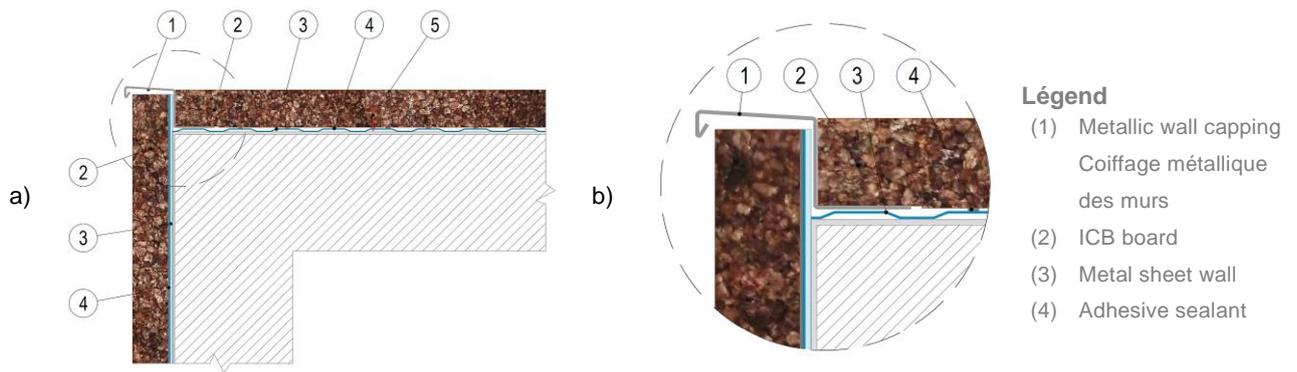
Connexion façade/toit plat : a) Vue générale ; b) Détail de l'application du couronnement du mur.
